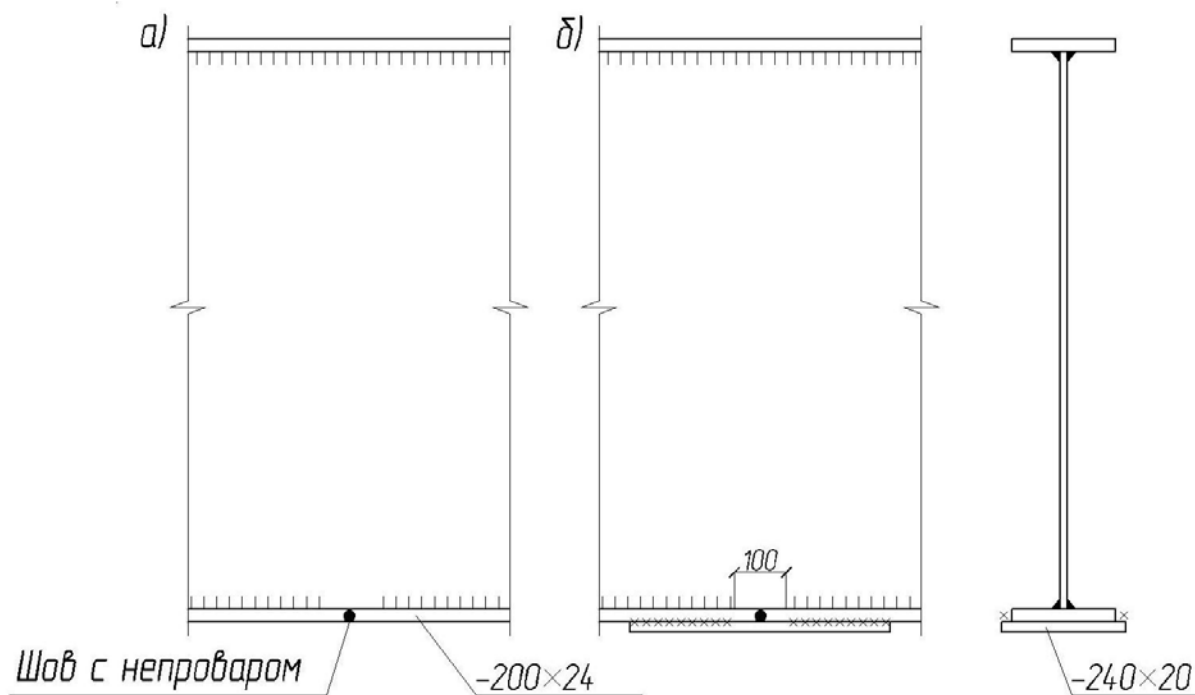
Усиление стыкового сварного соединения
